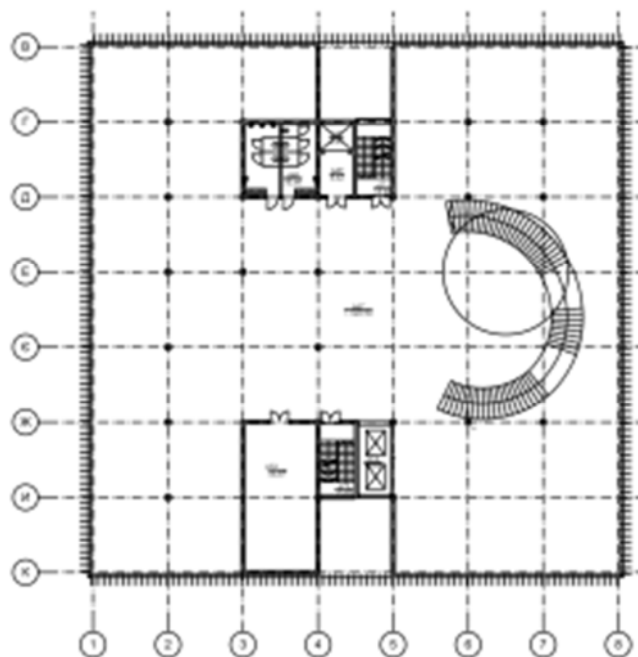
План 6-го поверху на відмітці 28.000 м
